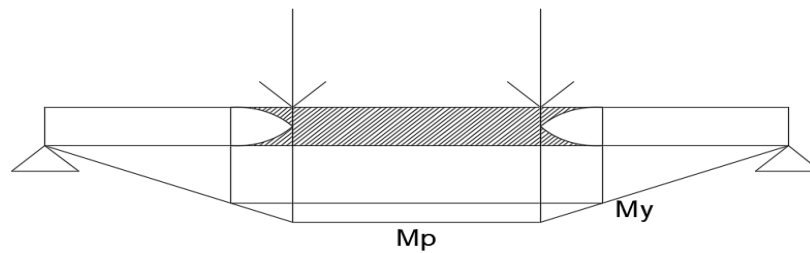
Viga suportando cargas pontuais de duas vigotas
